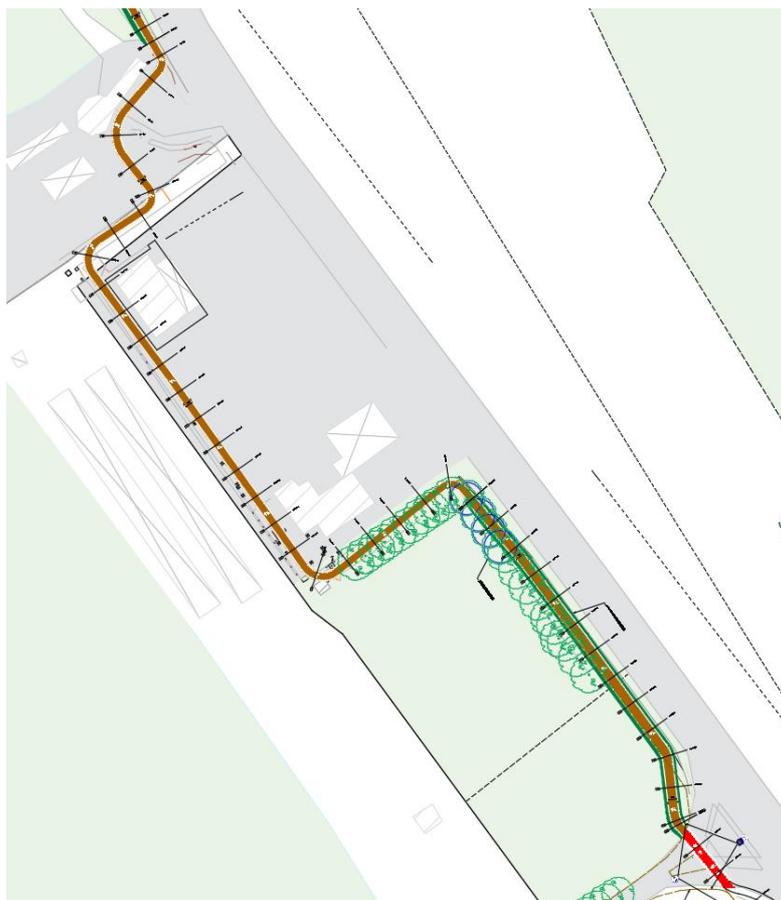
Estratto Planimetria di Progetto – Distributore Eni
